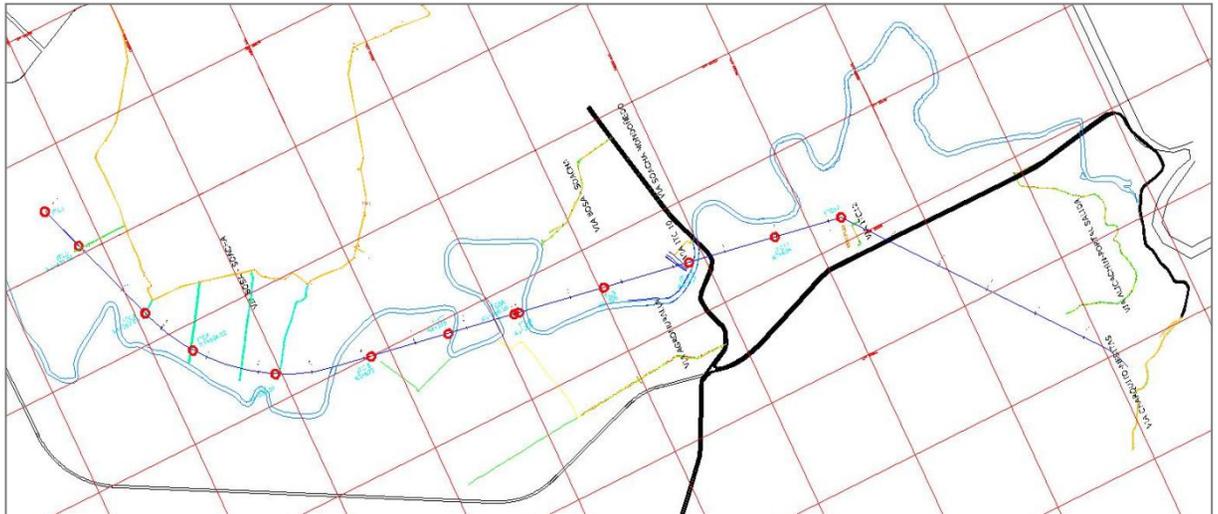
Levantamiento Topográfico de las vías de acceso al proyecto.
